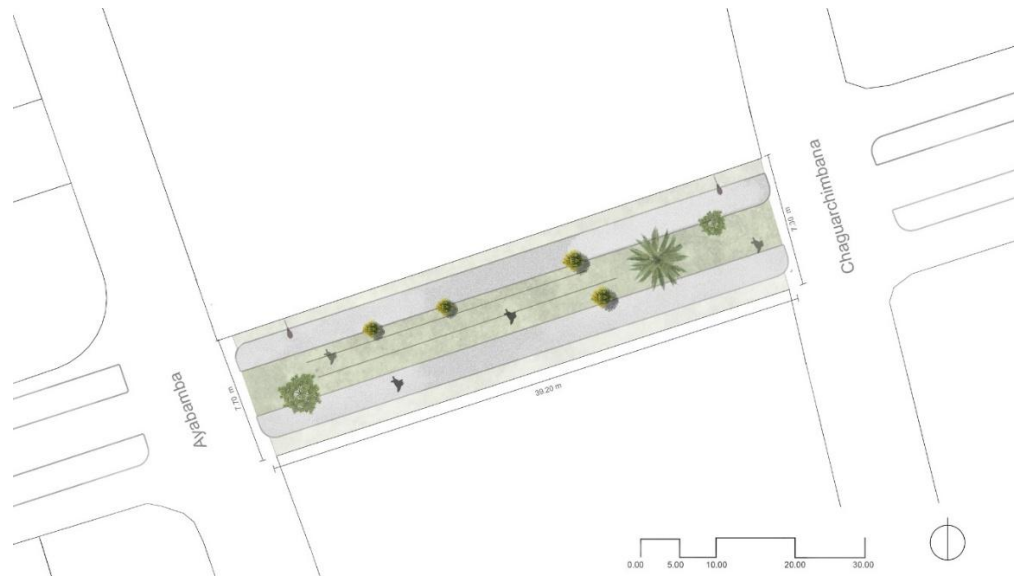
Tramo 3, planta arquitectónica del corredor de Galap. Elaboración propia (2025).
